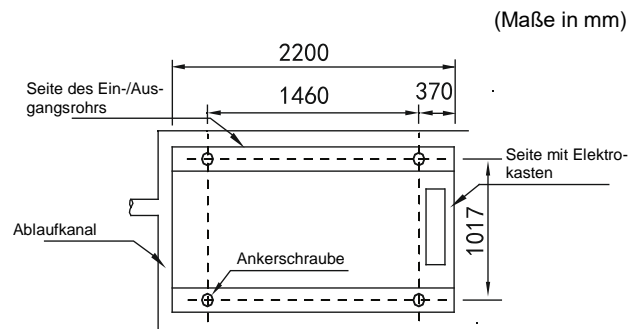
Skizze der Installationsmaße für SCV-900EBH und SCV-1400EBH – Draufsicht
